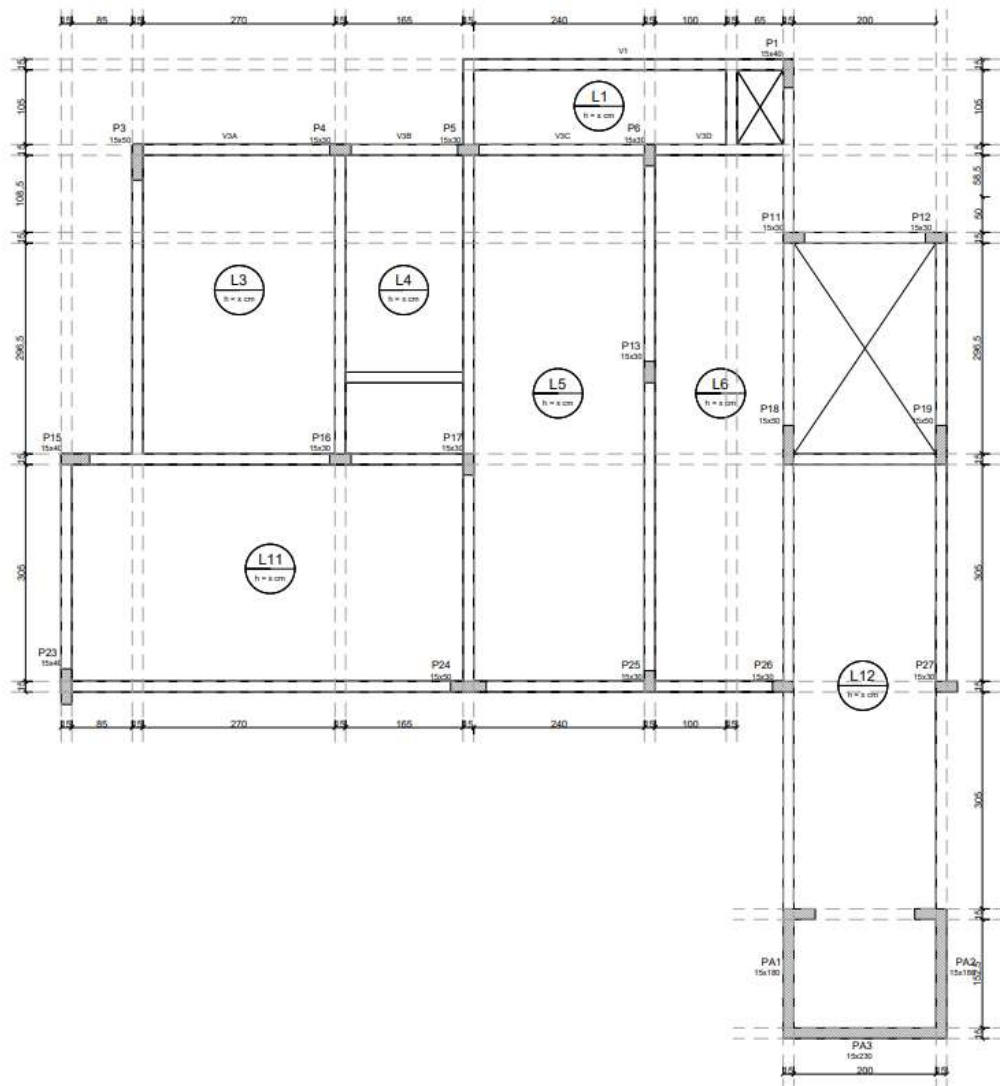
Planta de fôrmas apartamento tipo e circulação
